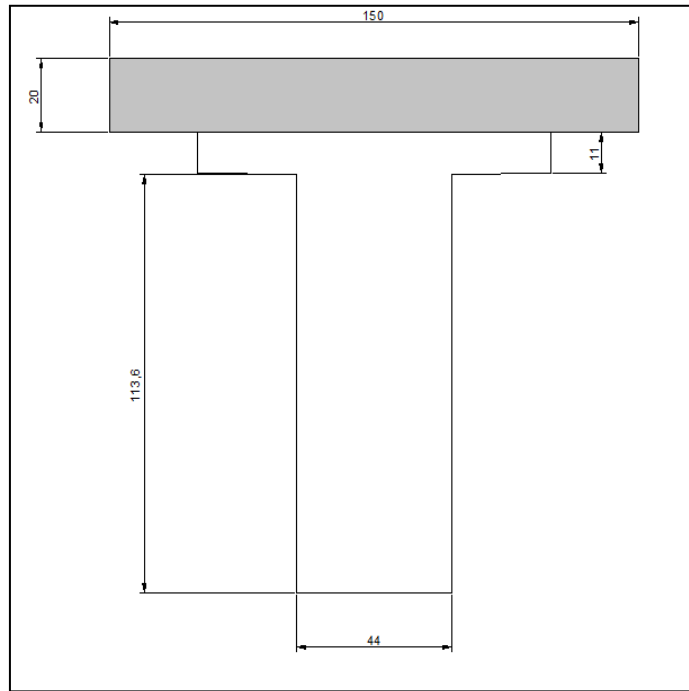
Section d'about de la poutre en BP plus l'hourdis général.
